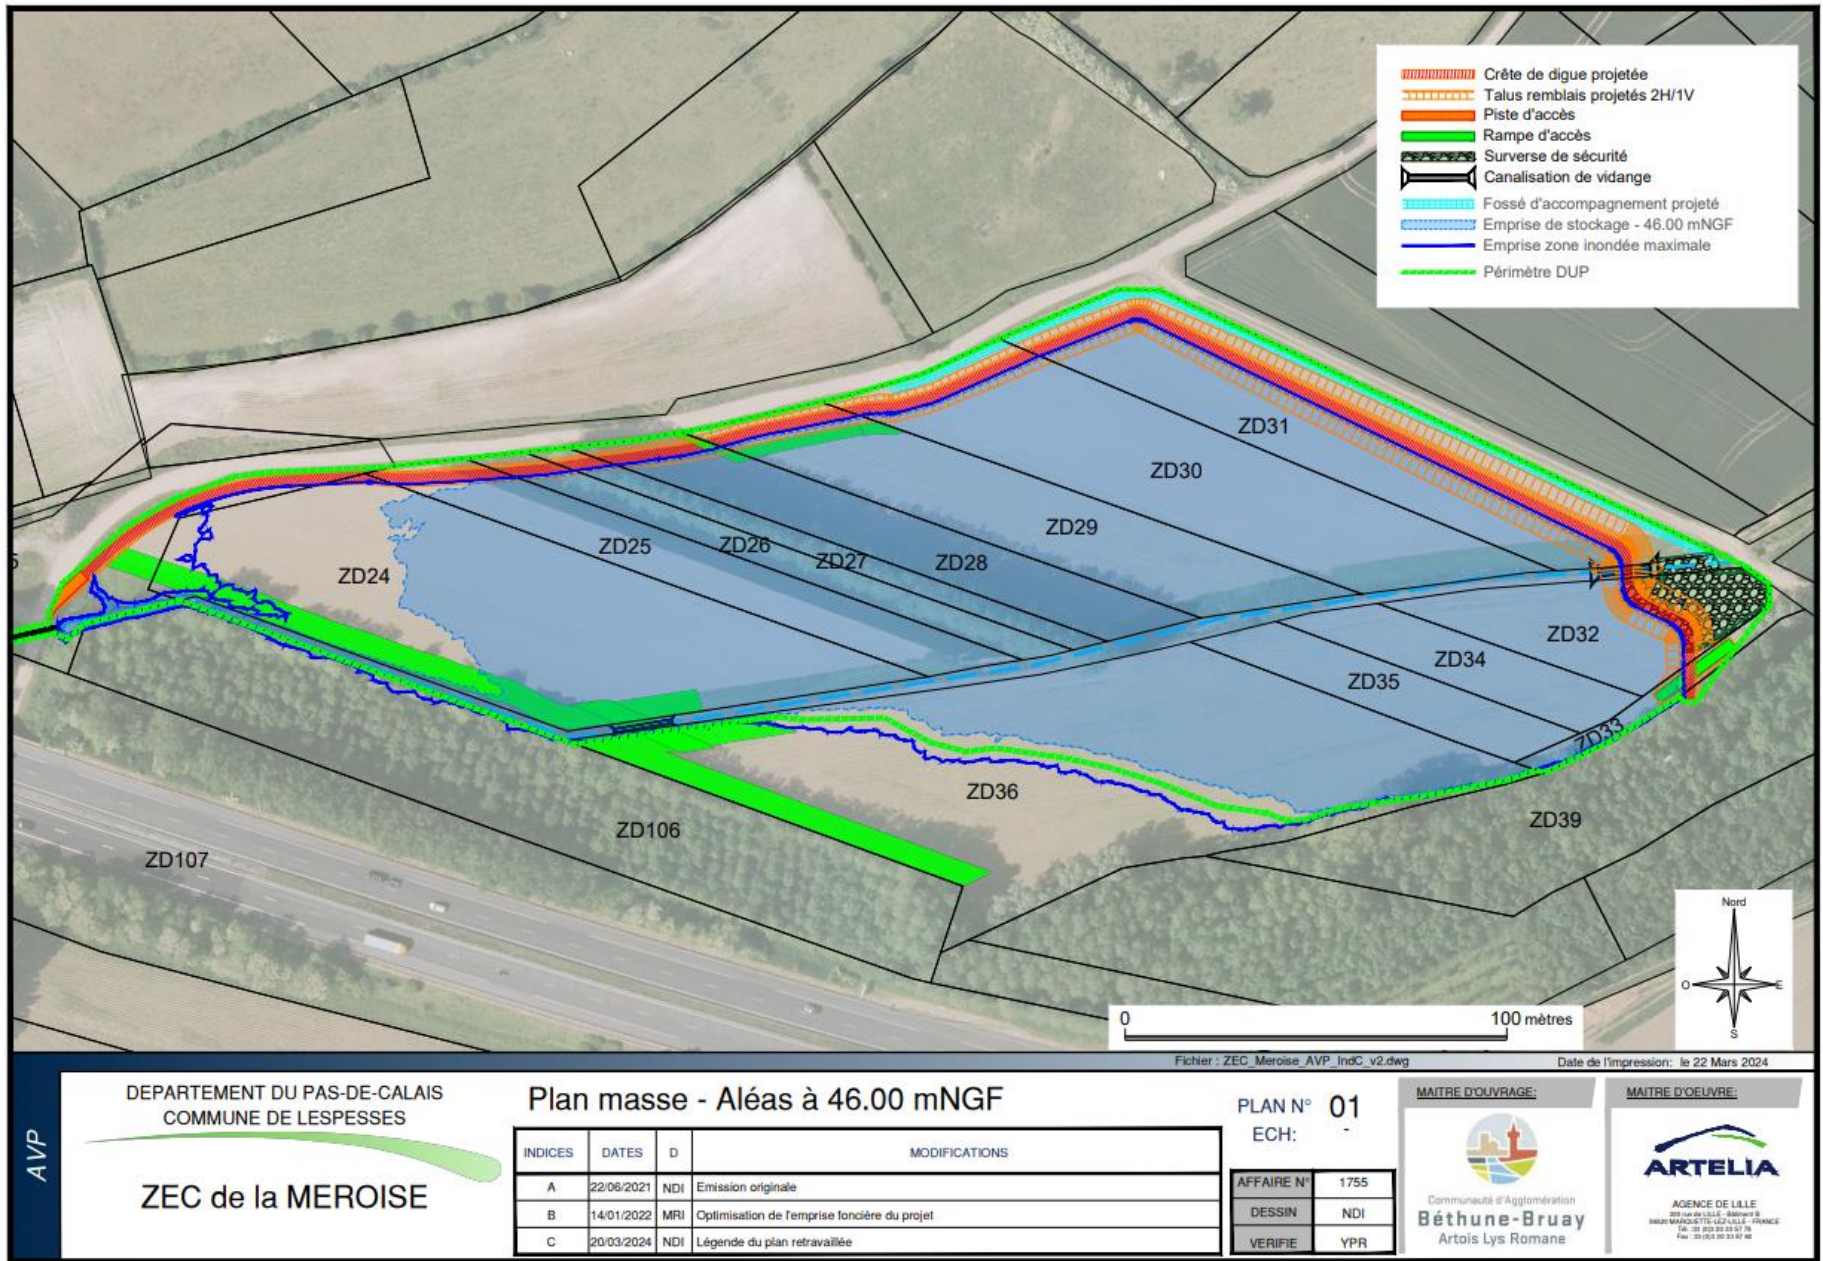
Plan général des travaux de la ZEC de la Méroise - Zoom
